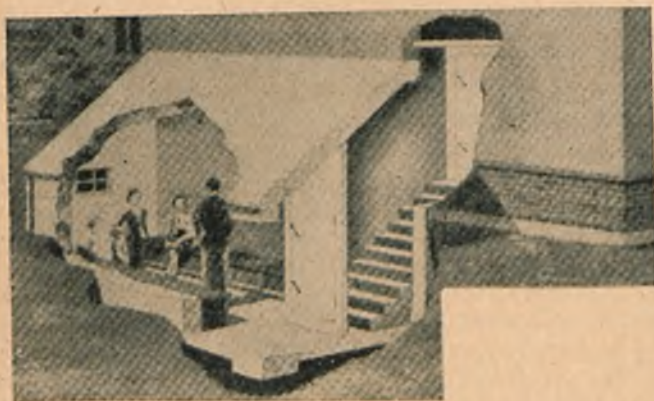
6 pokazują schrony betonowe, opracowane przez Stowarzyszenie Betonowe (Cement and Concrete Association). Na rys. 4 widzimy schron przy domku jednorodzinny, który podczas pokoju służy jako cieplarnia ogrodowa. Ściany żelbetowe grub. 30 cm (25 cm przy specjalnym zbrojeniu). Rys. 5 i 6 przedstawiają schrony publiczne dla przechodniów, jeden z nich (5) na dziedzińcu dużego budynku administracyjnego, drugi (6) pod zieleńcem, urządzone jako zajezdnia samochodowa. W Anglii szczególną uwagę zwracają na to, aby schron, mógł być wyzyskany i w okresie pokojowym. Na rys. 7 — 9 widać schron, w którym urządzono postój dla rowerów. Otwory świetlne mogą być odpowiednio w razie potrzeby zasłonięte.
